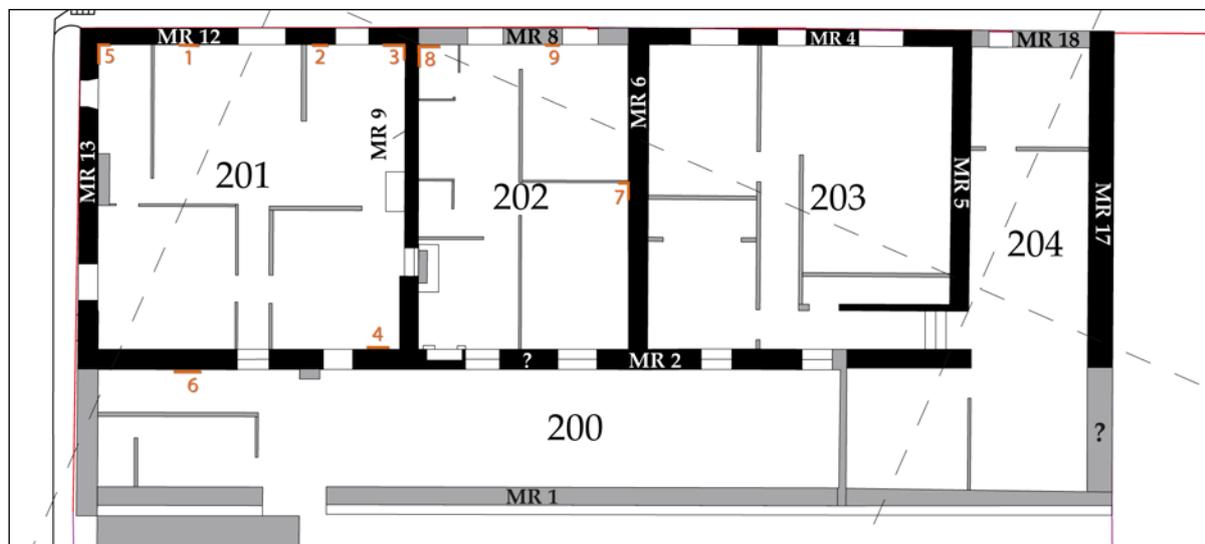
Plan de localisation des faits de l'espace 200 (DAO M. Panneau, S. Ranchin)
